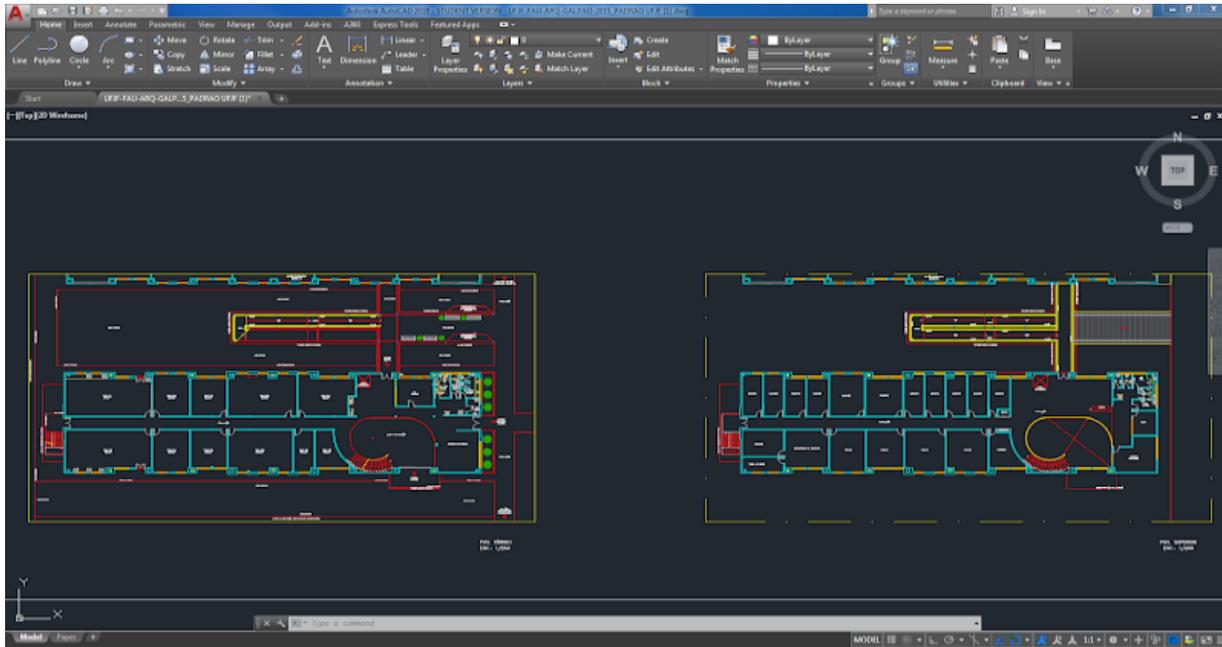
Vista geral do Arquivo AutoCAD existente.
